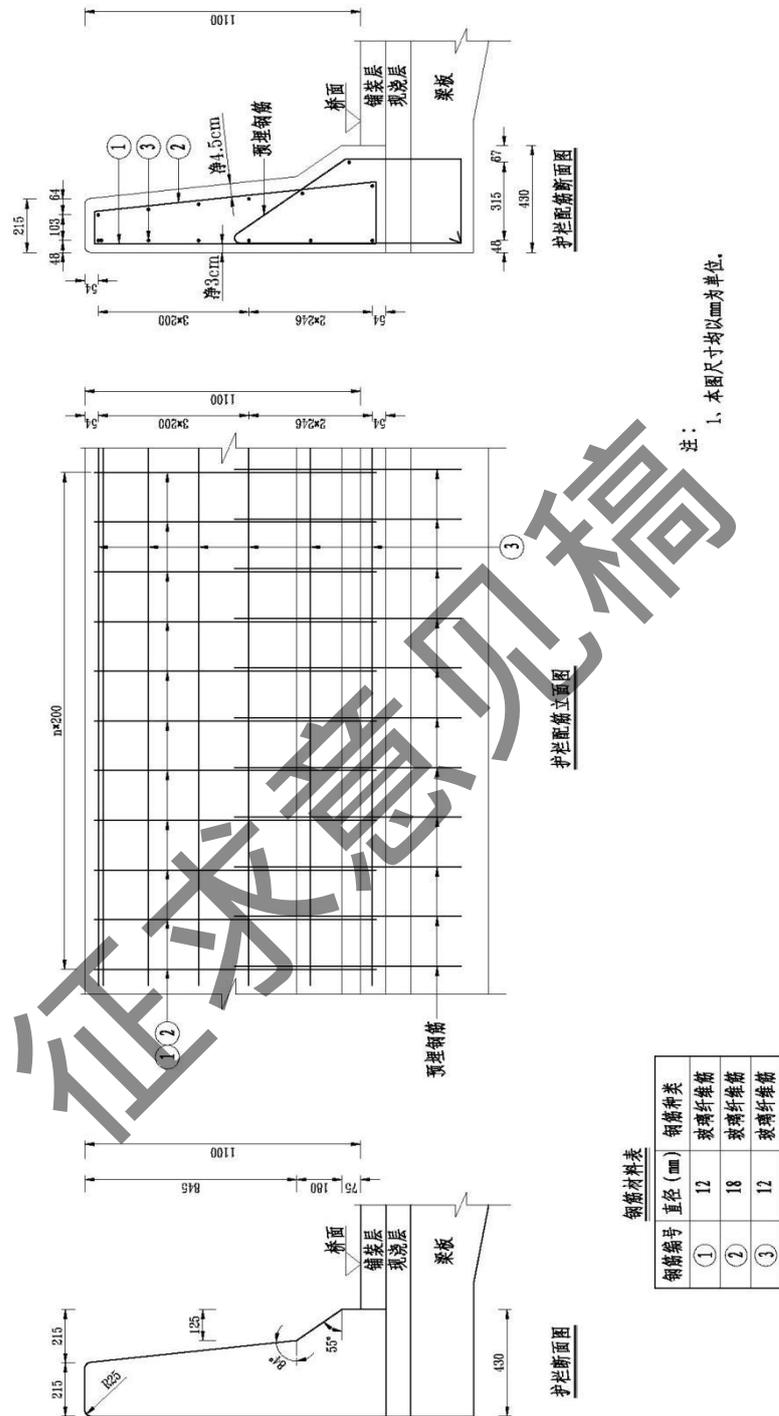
桥梁玻璃纤维钢筋混凝土护栏一般构造图
